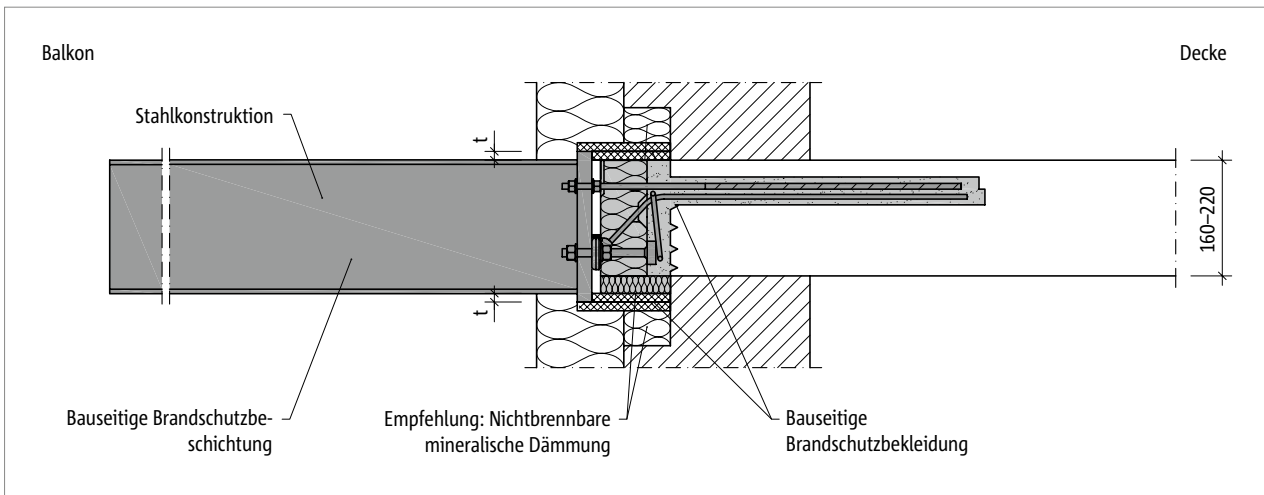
Schöck Isokorb® RT Typ SK: Bauseitige Brandschutzbekleidung RT Typ SK und brandschutzbeschichtete Stahlkonstruktion; Schnitt
